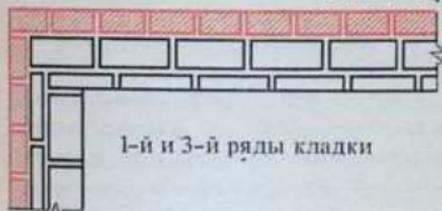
Перевязка кладки из легкого бетона с облицовкой кирпичом:
